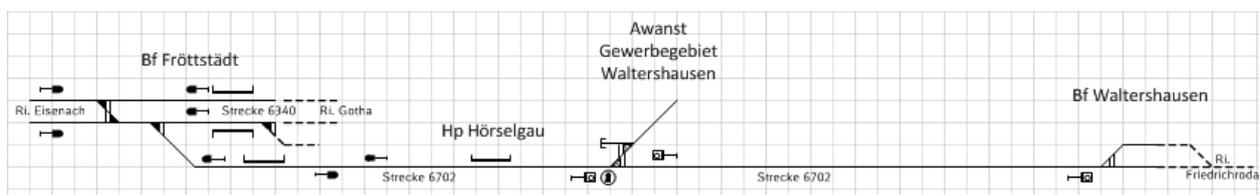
Lageplanskizze Awanst Gewerbegebiet Waltershausen nach Infrastrukturvariante 2 mit der Zuglaufstelle
